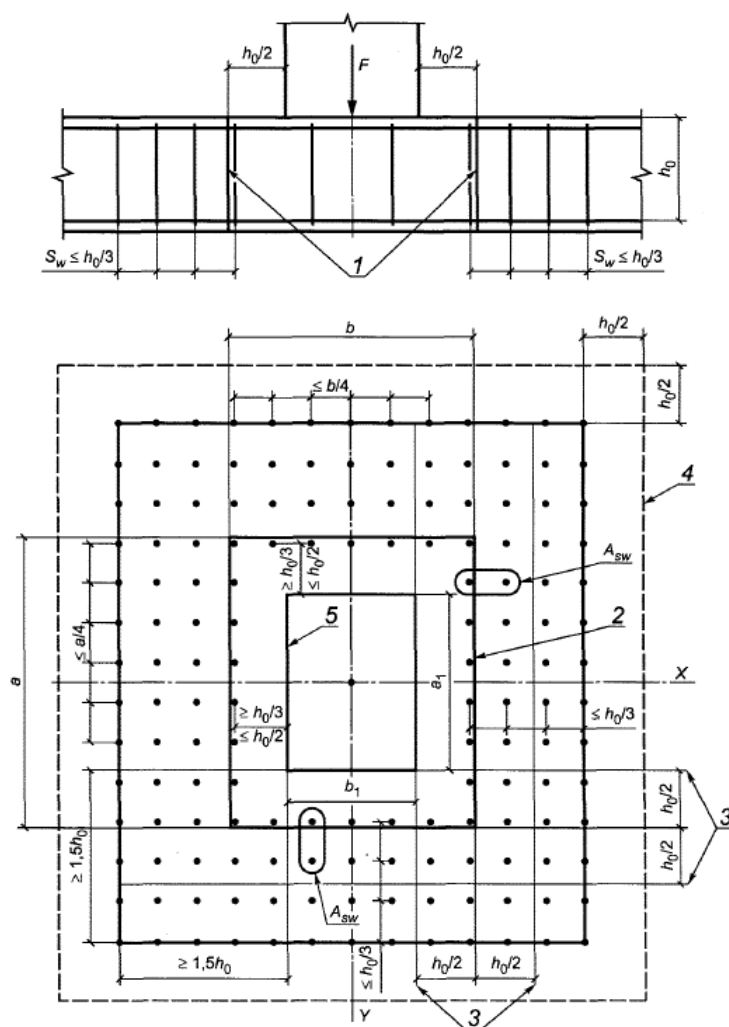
СП 63. – Схема для расчета железобетонных плит с вертикальной равномерно распределенной поперечной арматурой на продавливание
